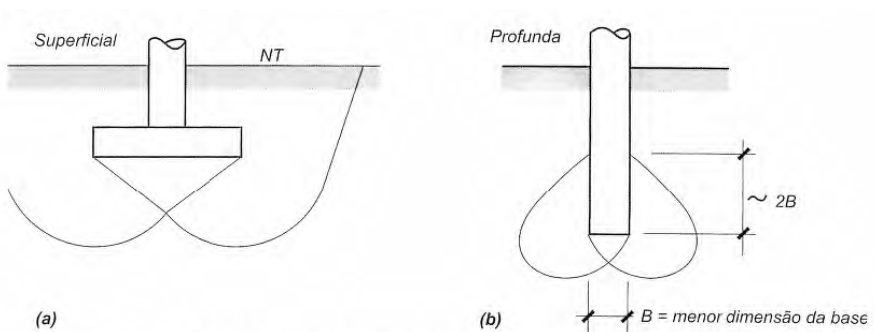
a) Fundação superficial; b) Fundação Profunda.
